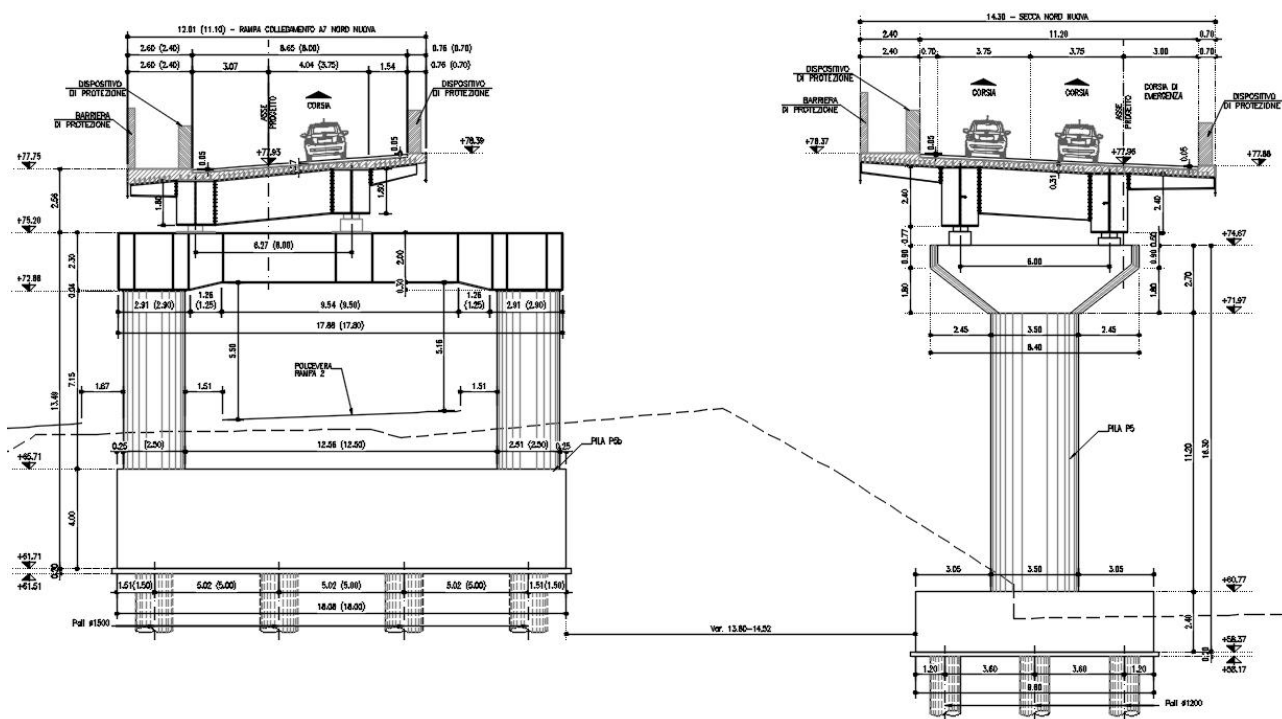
Pila a mensola - Sezione trasversale Pila P5 – P5b
